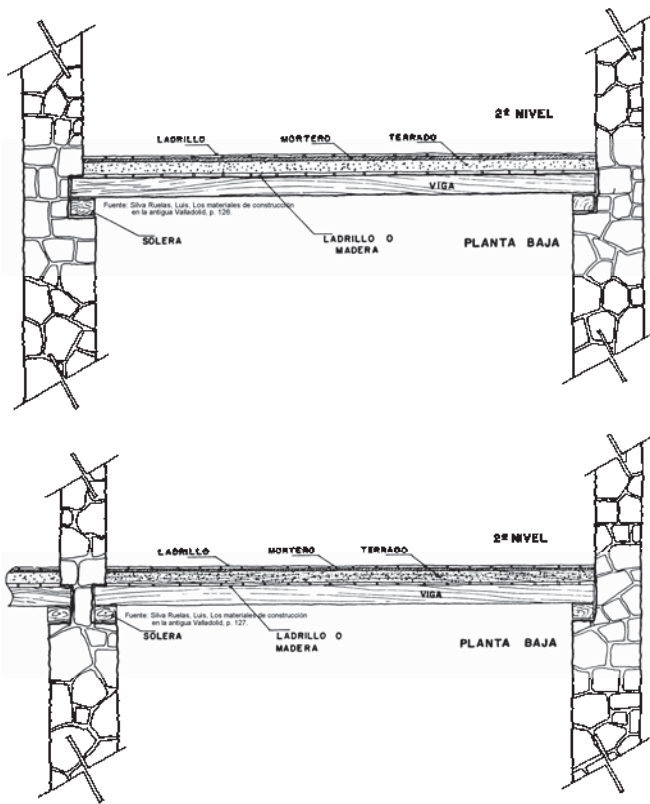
Sistema constructivo de entrepiso y empotramiento de vigas de madera en muros
